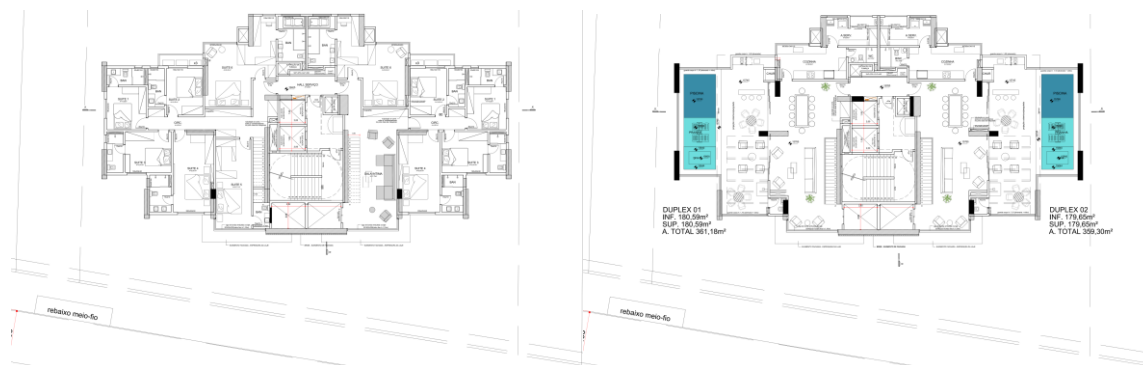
Pavimento Duplex Inf., à esquerda; Pavimento Duplex Sup., à direita
